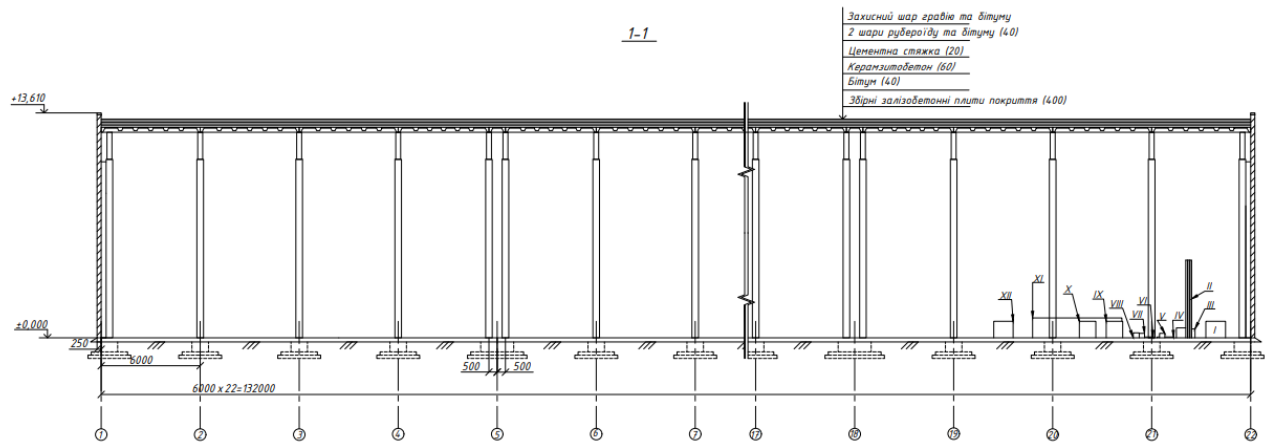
Поздовжній розріз цеху №65 з розміщенням очисних споруд в масштабі 1:100
